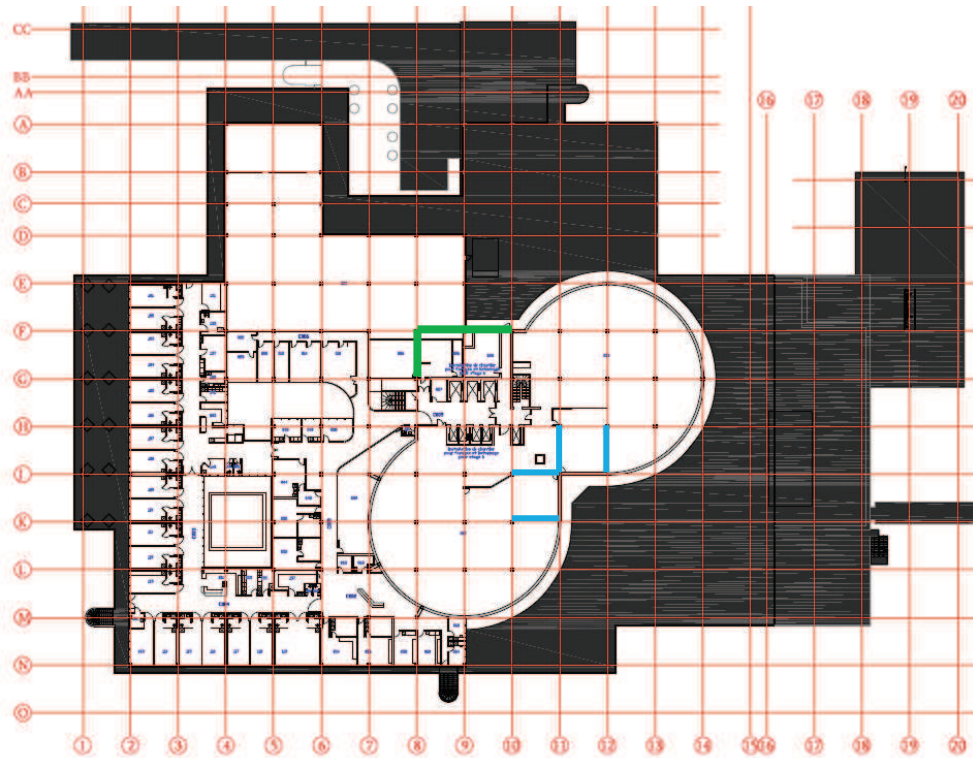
Plan du 2^{ème} étage, niveau C. Nouveaux murs en béton armé.
